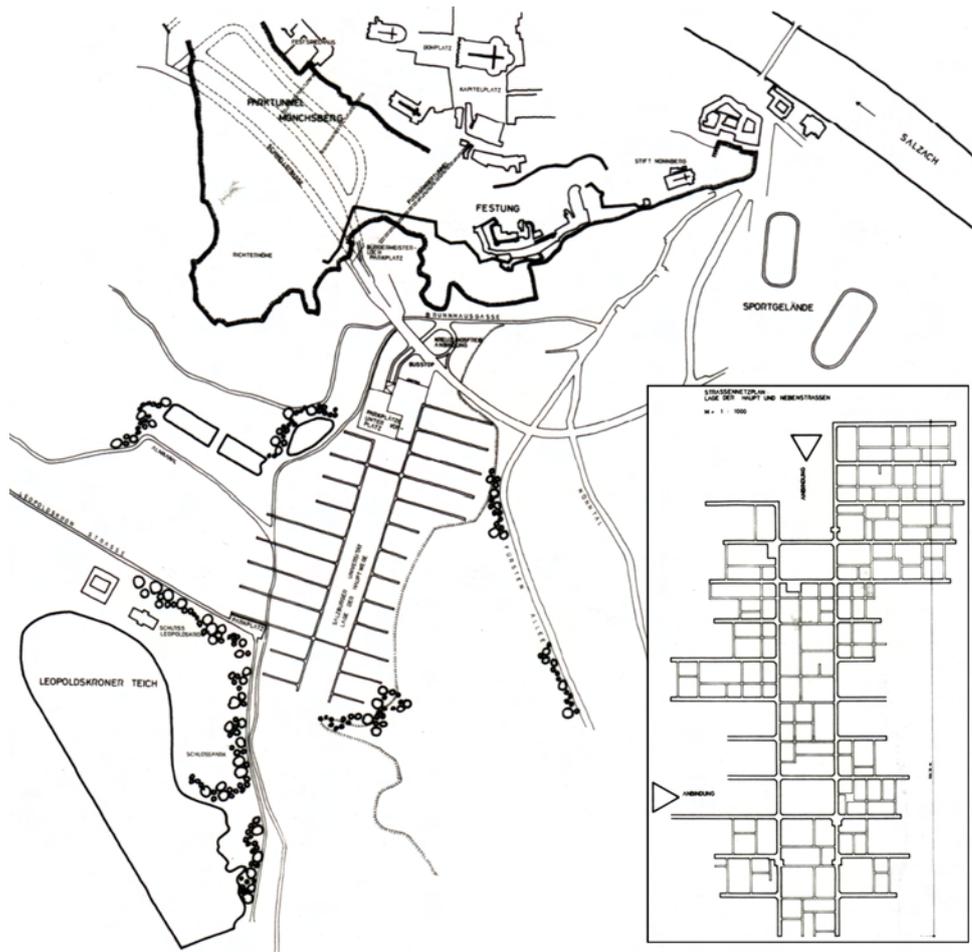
Lageplan mit Vergrößerung des Straßennetzes
